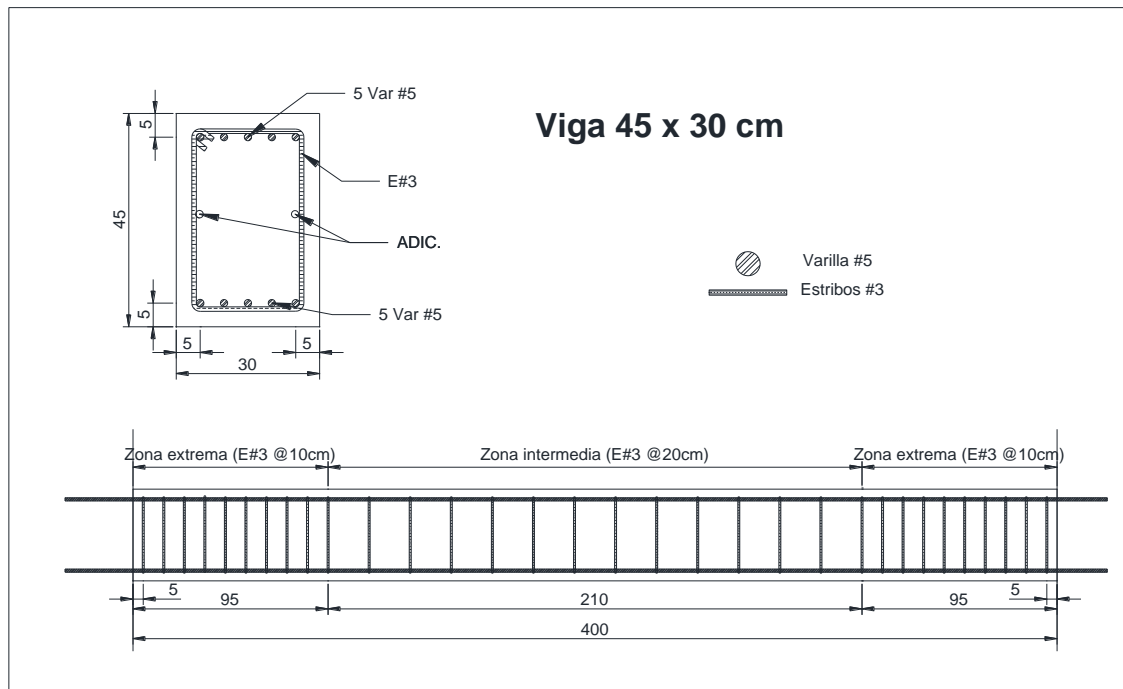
Armado tipo de la viga con sección transversal de 45 x 30 cm.
